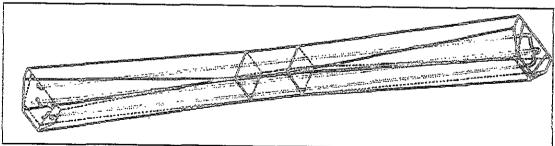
(Durmiente monolítico de concreto presforzado)
